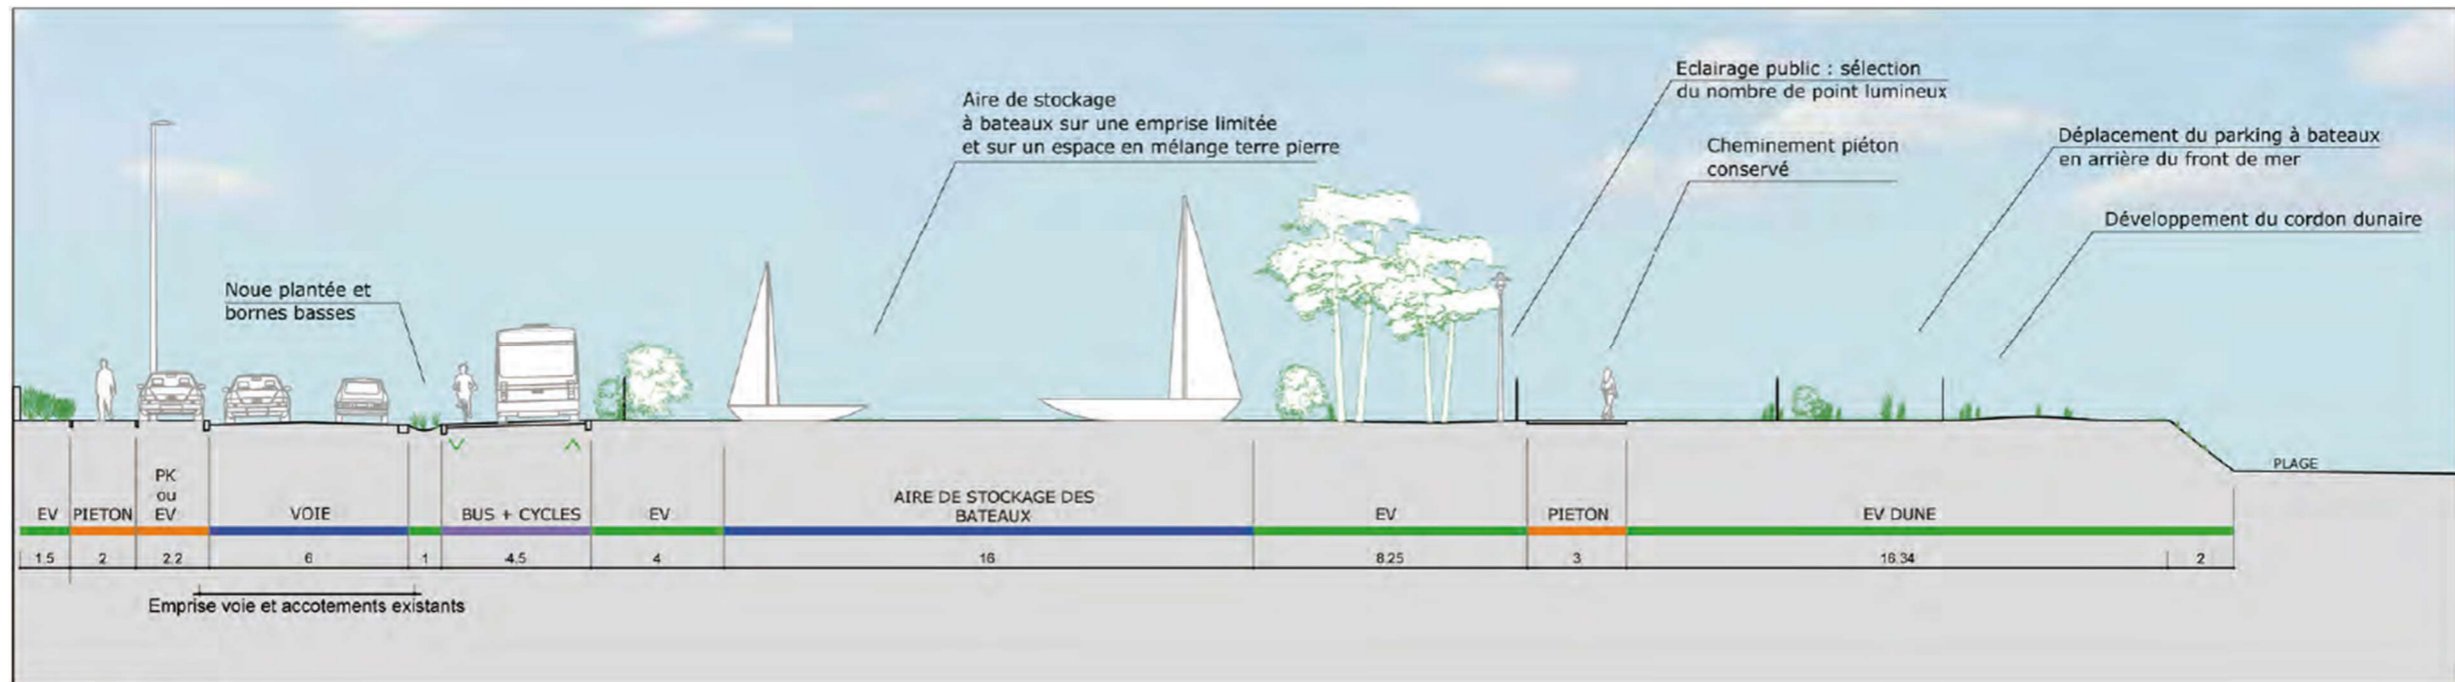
Coupe de principe avenue des dunes – aire de stockage des bateaux - du projet d'aménagement « 2. Aménagement du site propre et requalification de la plage sud de Rivedoux »
